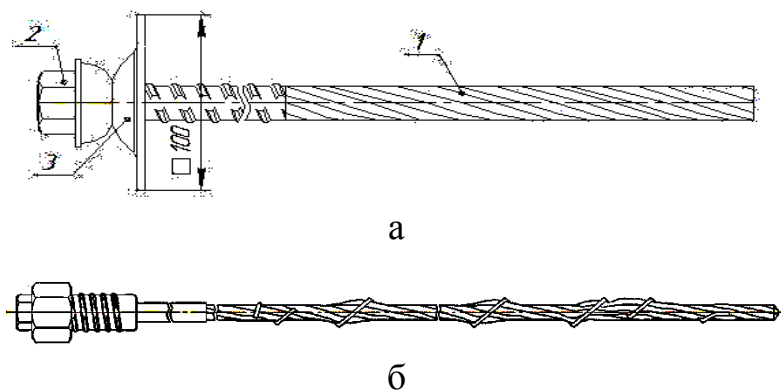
Общий вид канатных анкеров. а – канатный анкер АК01 (-08, -14) для химических и минеральных скрепляющих составов; б – канатный анкер КАГ-20. 1 – стержень анкера сварной, 2 – гайка, 3 – шайба опорная
